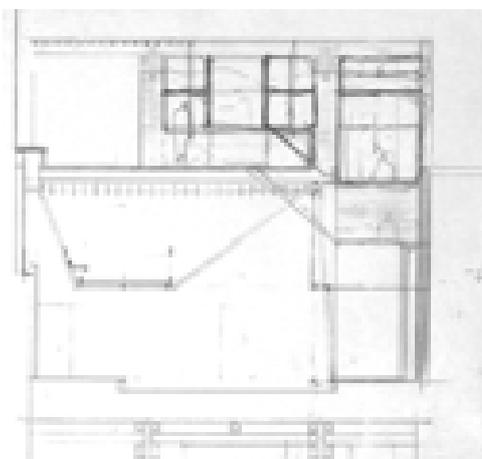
Studio sezione passerella – progetto del 1980 (AABS-95.502)
